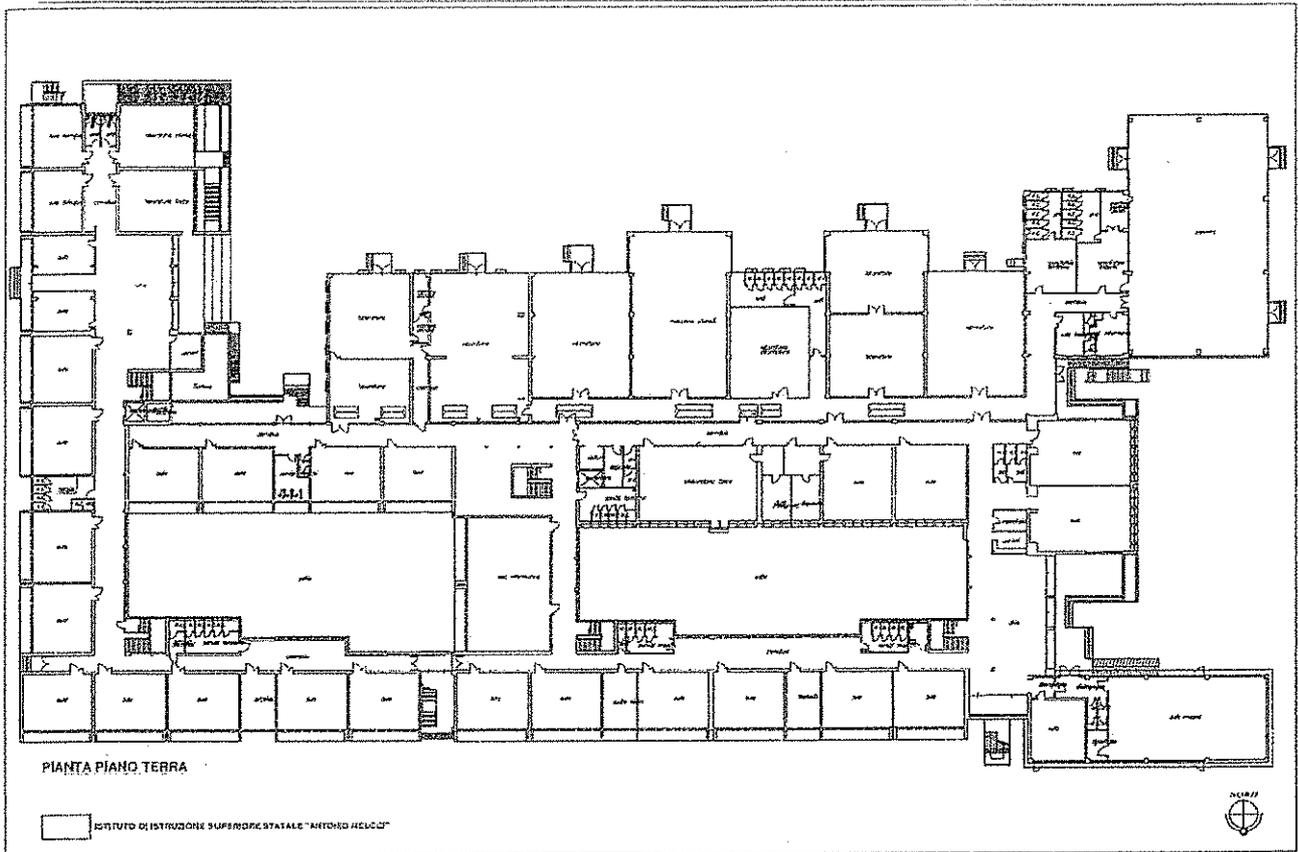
PLANIMETRIA INTERNA PIANO TERRA
